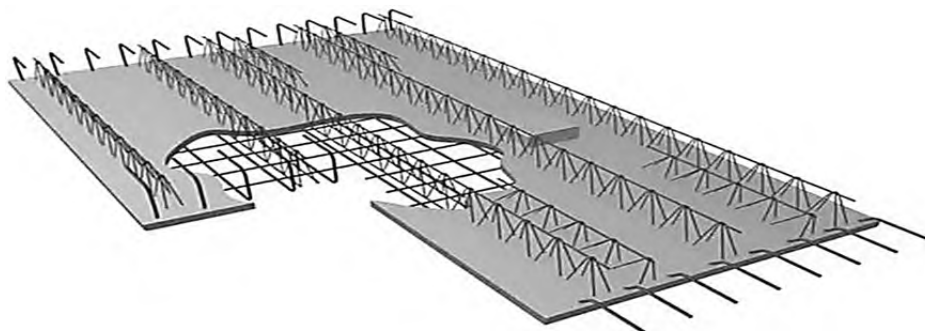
Конструкция сборно-монолитного перекрытия с несъемными тонкостенными плитами
